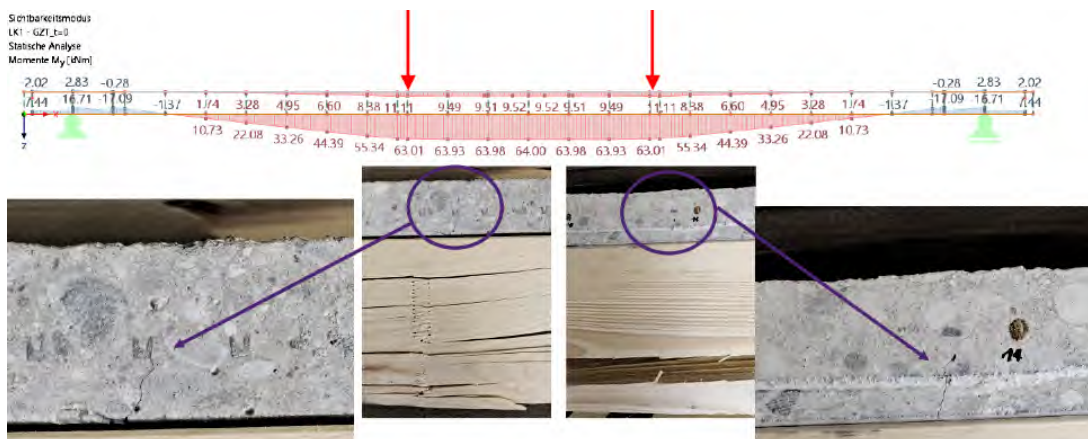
Risse im Stahlbeton. An der Stelle der punktuellen Einleitung der Prüflast im 4-Punkttest entsteht ein Momentengelenk in der Betonplatte. Es kommt zu einer Umlagerung des Biegemoments zum Holzquerschnitt.
